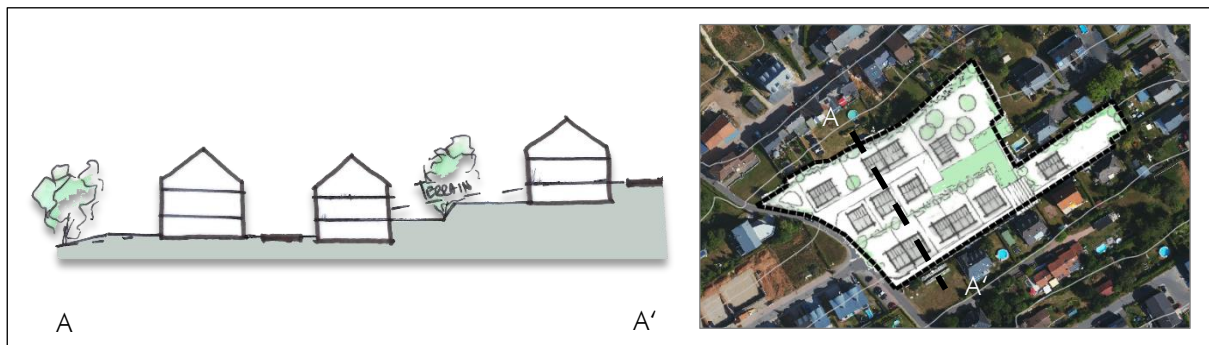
Prinzipschnitt durch das Plangebiet. Quelle: CO3 2021
